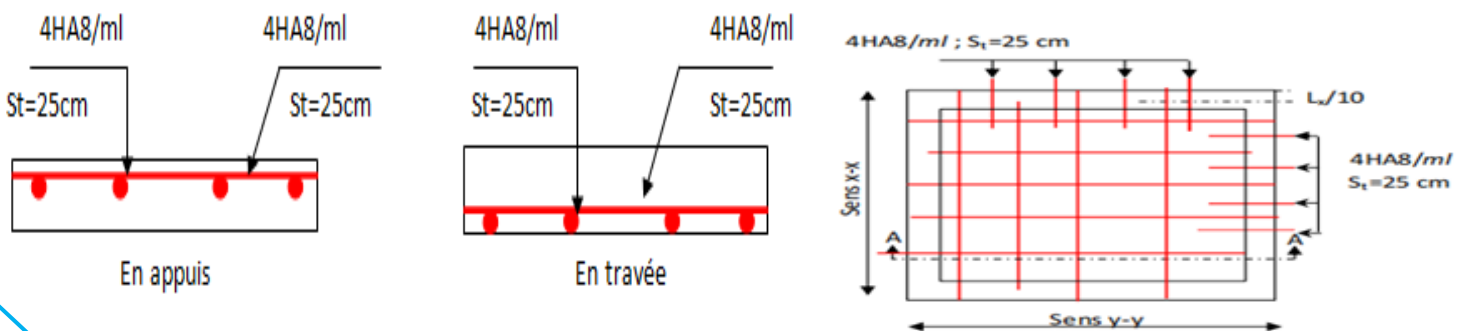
Schéma de ferrailage de dalle pleine au-dessous de l'ascenseur.
